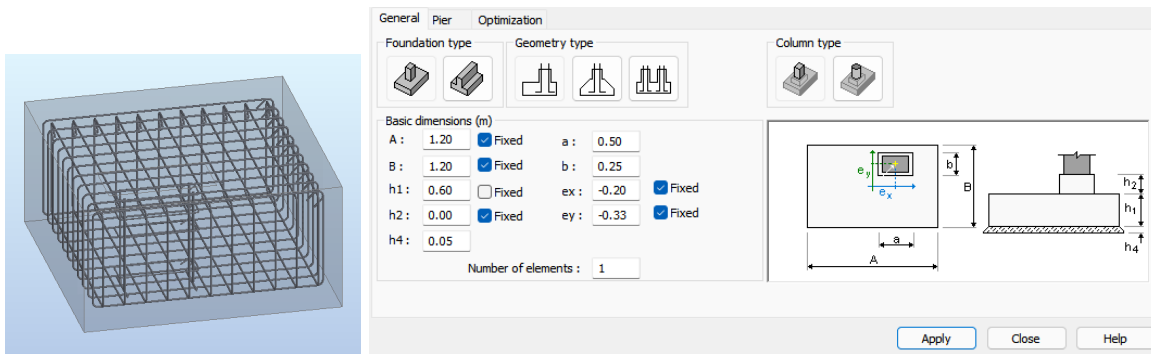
Parâmetros e dimensões adotadas para a sapata isolada sob o pilar de canto.
